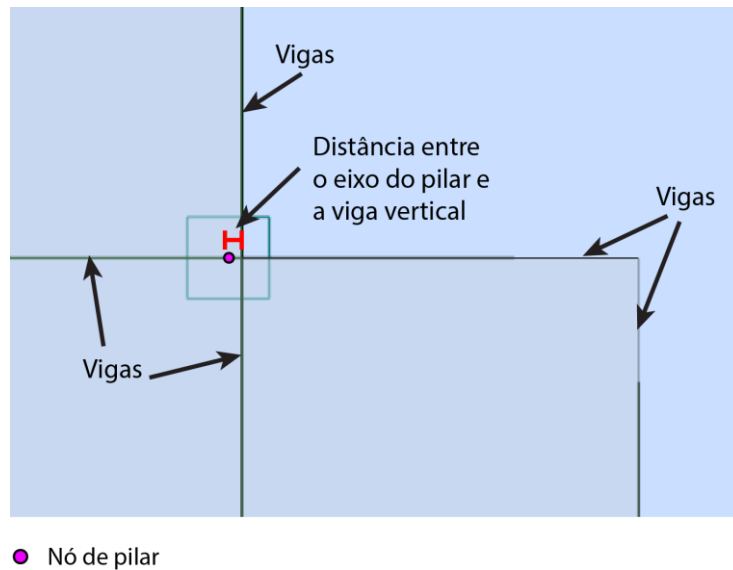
Trecho rígido entre um pilar e uma viga no RSA.
